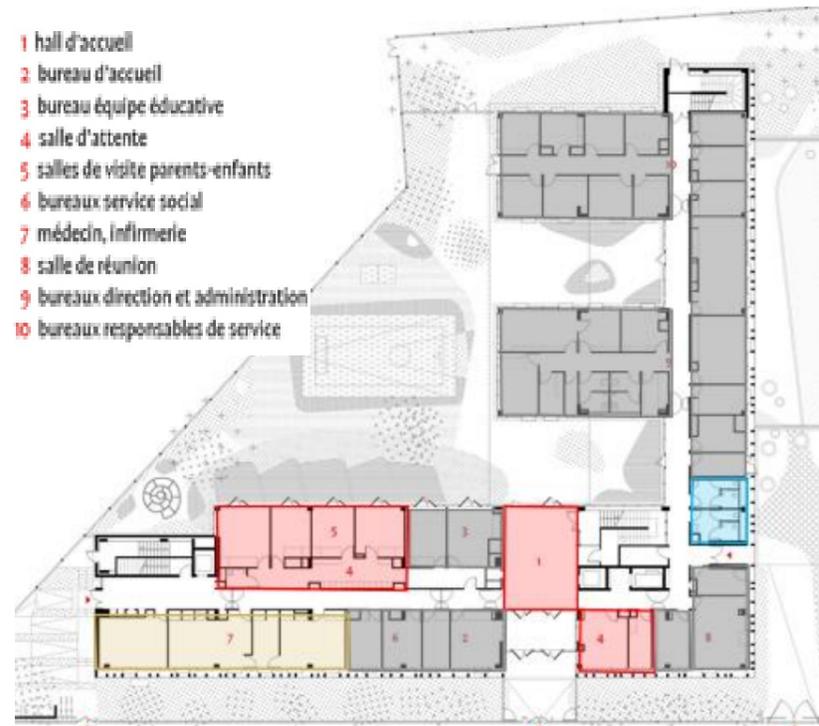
Plan Rez de Chaussée Eleanor Roosevelt⁸⁸
